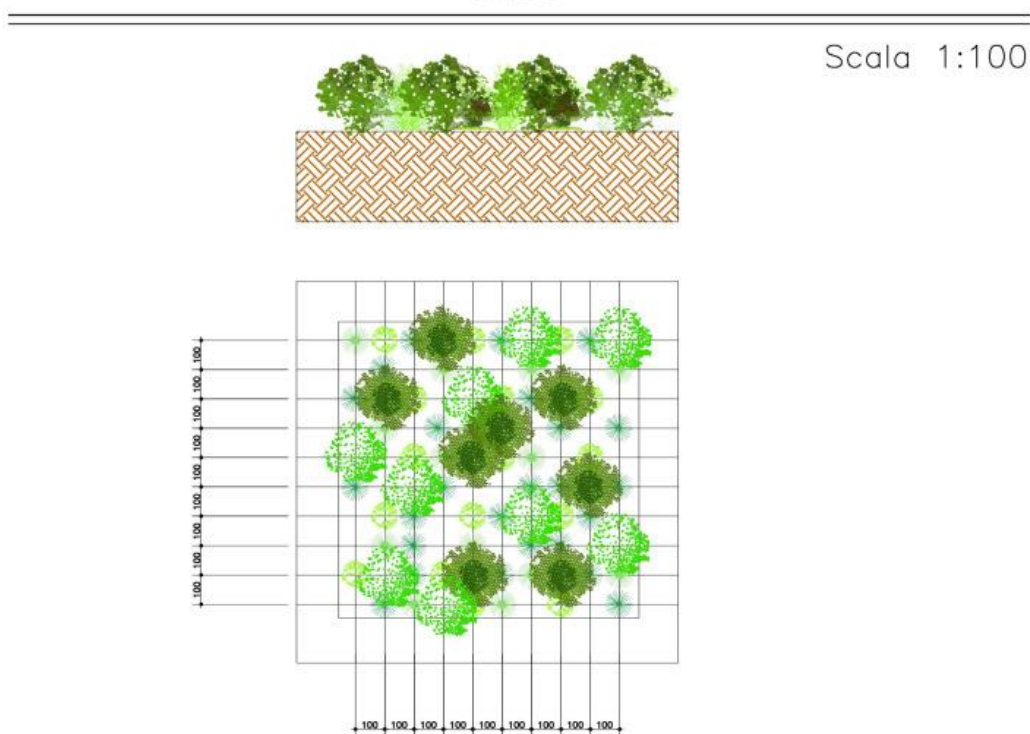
MODULO F – Rafforzamento delle aree umide
